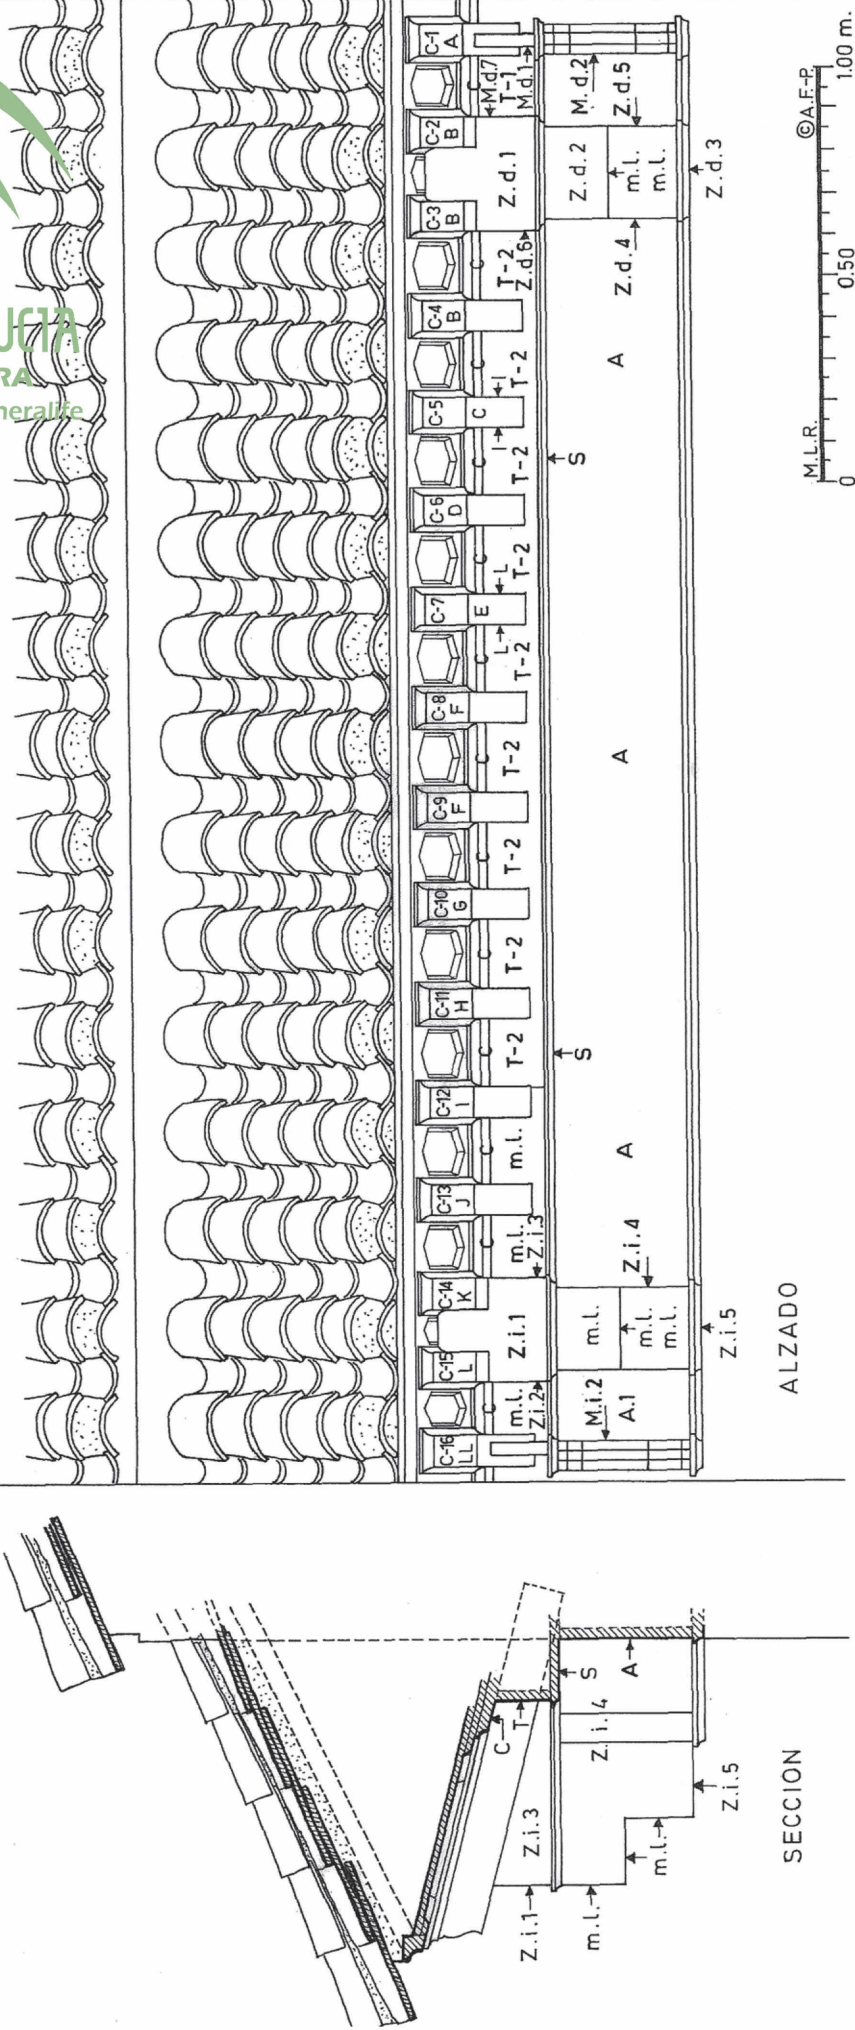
Alero de la fachada con los elementos de madera tallada identificados y enumerados. Alzado y sección. Archivo: A. Fernández-Puertas
